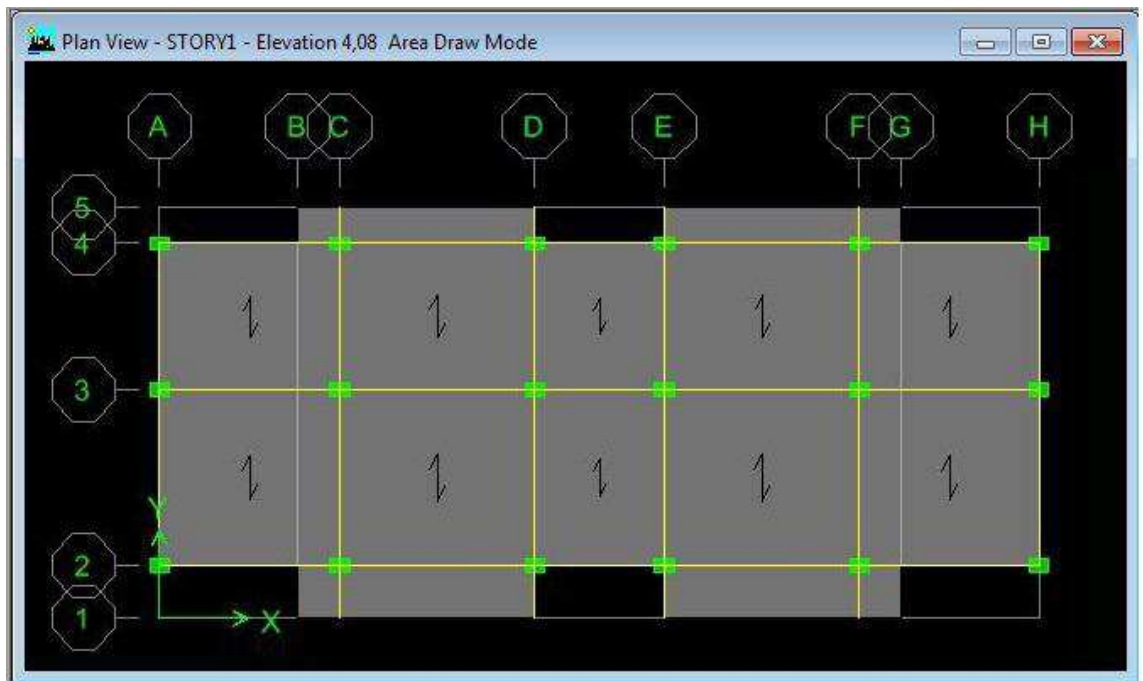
Vue en plan du plancher de rez-de-chaussée.
